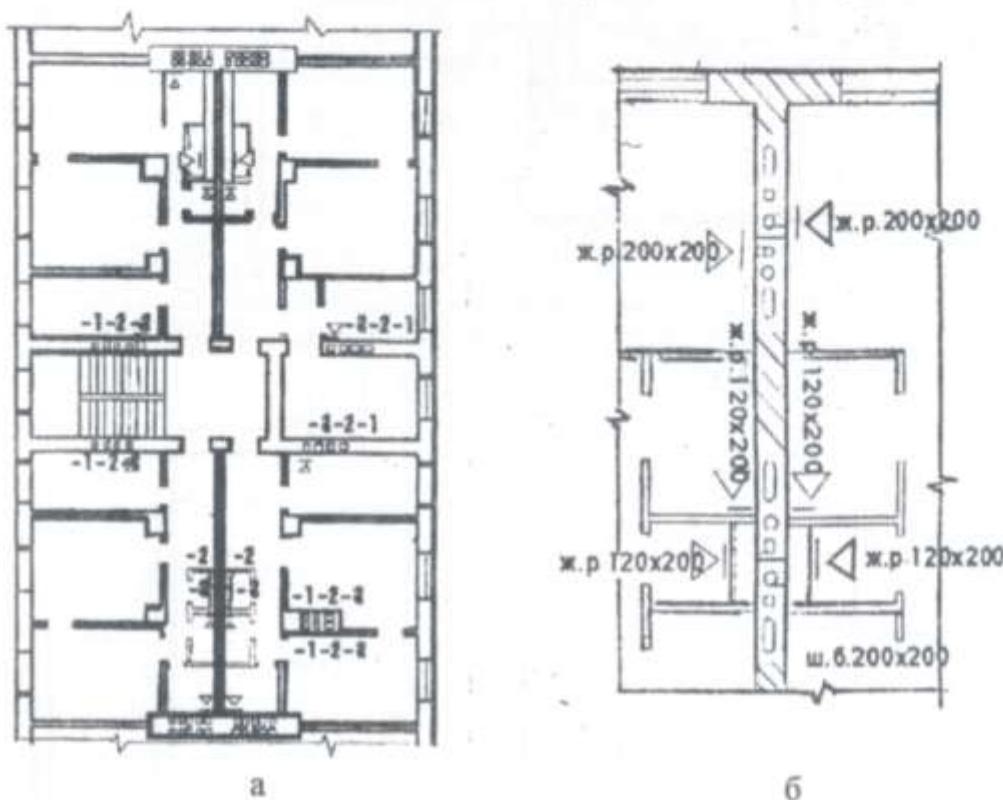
Нанесение вытяжных вентиляционных решёток и каналов на поэтажный план здания: а – вытяжная вентиляция жилого здания с размещением вентиляционных каналов в капитальных внутренних стенах и двухрядных вентиляционных панелях; б – фрагмент плана вентиляции кухни и санузлов с размещением каналов в вентиляционных панелях с вертикальным транзитным каналом; ж. р. 120x200 и ж. р. 200x200 – размеры вытяжных жалюзийных решёток
